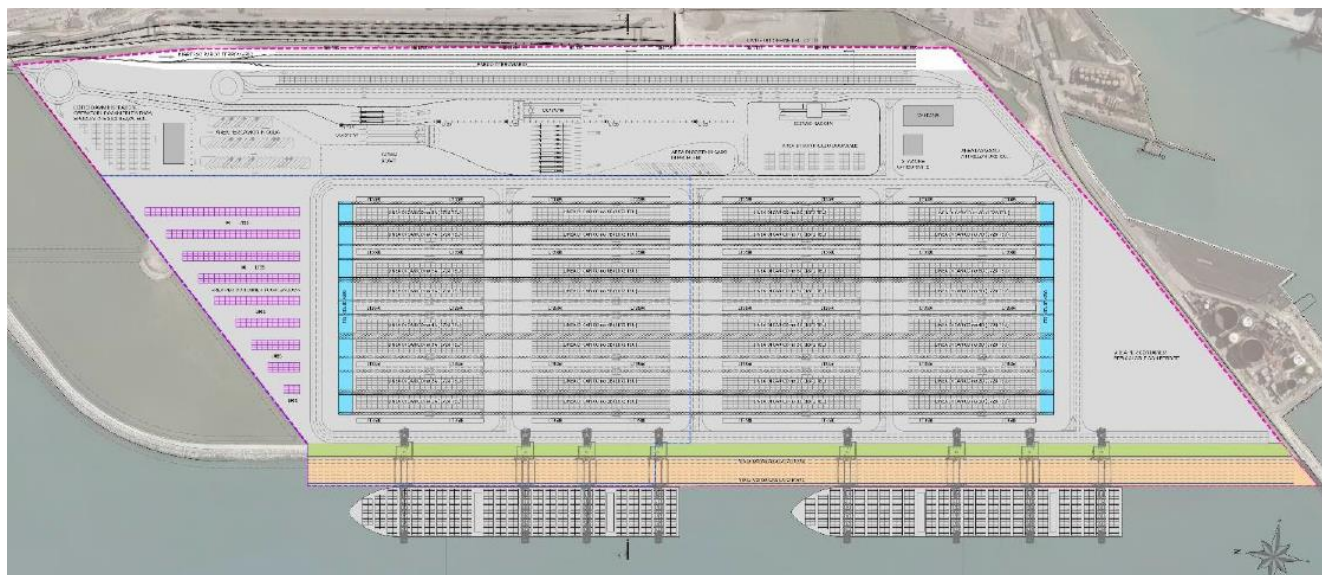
Layout del Terminal Container (estratto dal PFTE 2021) [opera non facente parte dell'oggetto del presente SINcA]
